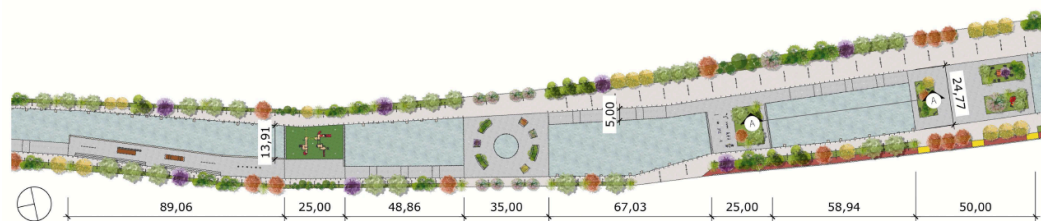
Planta Layout Trecho 02. Fonte: Autoral, 2022.
